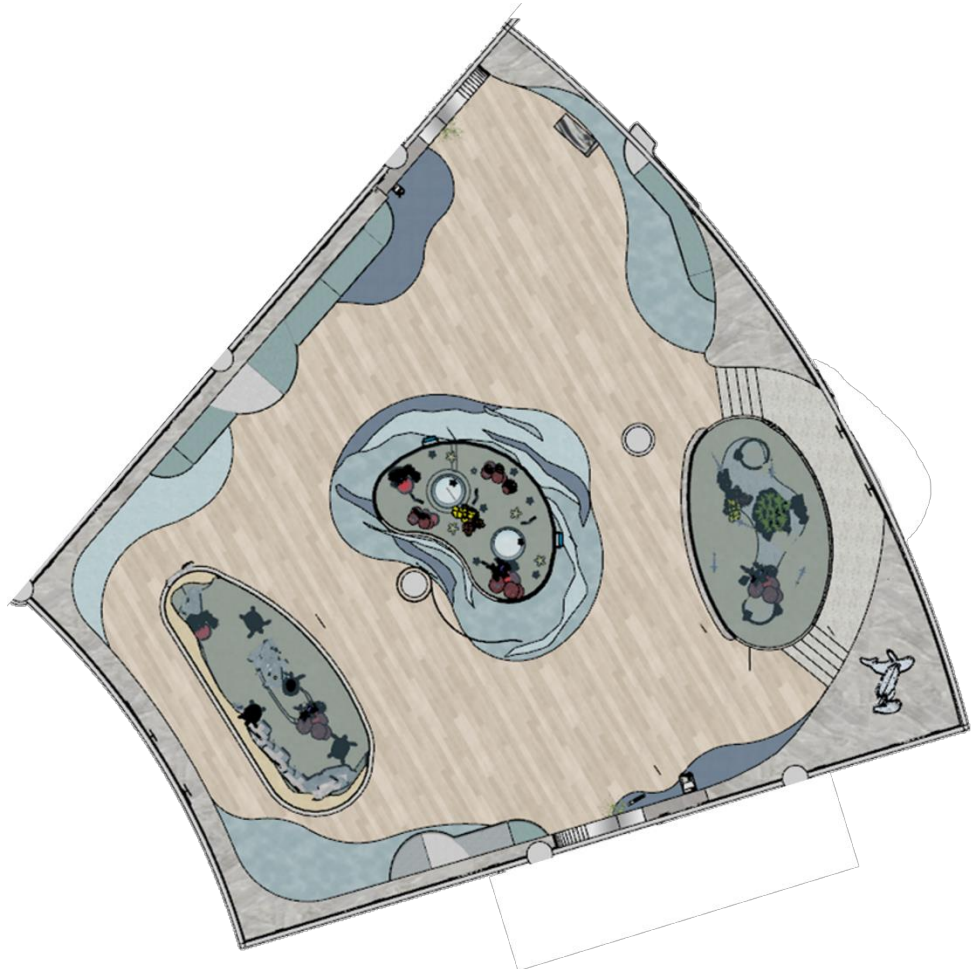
12 Detail Arsitektur Ruang Terpilih 1
